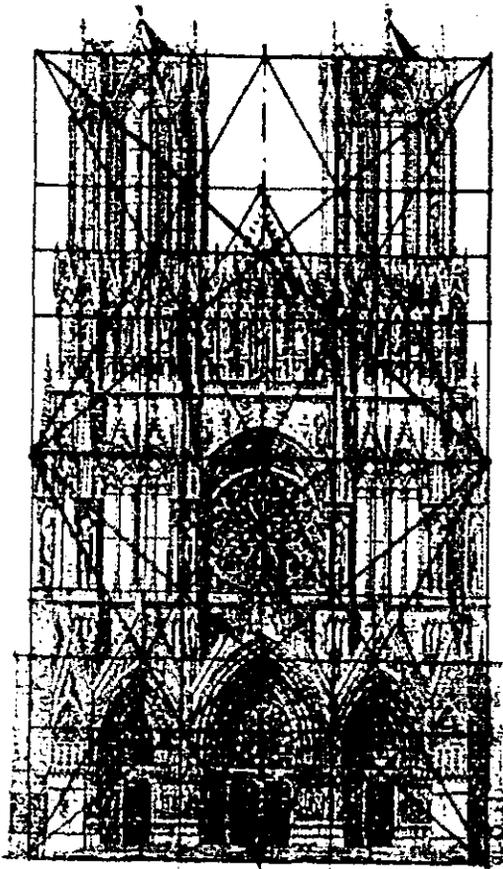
Catedral de Reims, trazo de la fachada principal.
